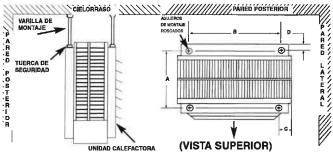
Montaje y espaciado de varillas para descarga horizontal
